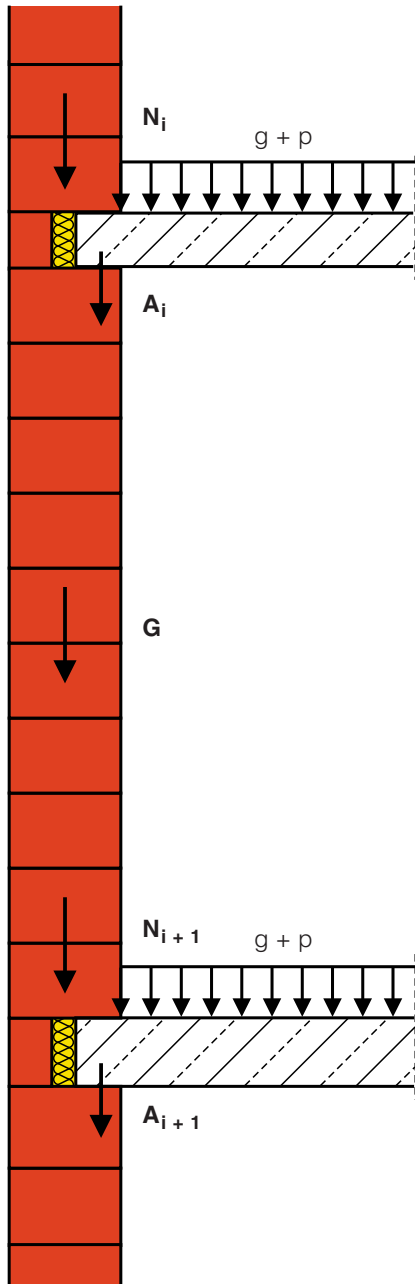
Belastungen vertikal beanspruchter Mauerwerkswände
